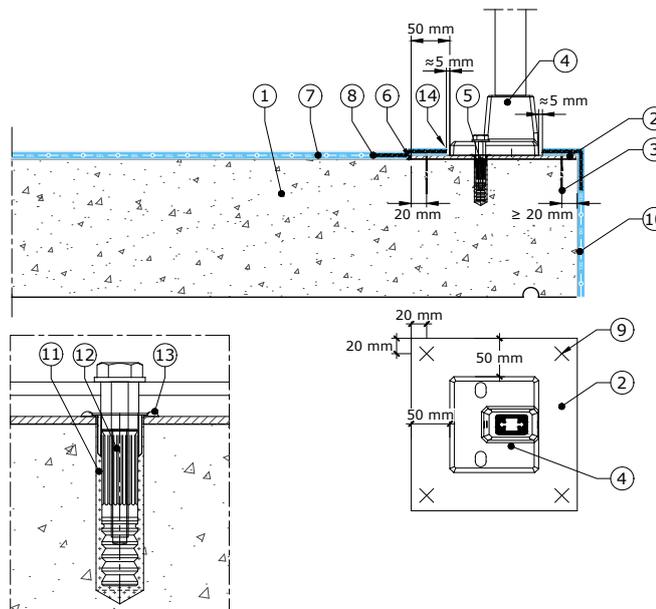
Garde-corps avec fixation sur dalle - Exemple
